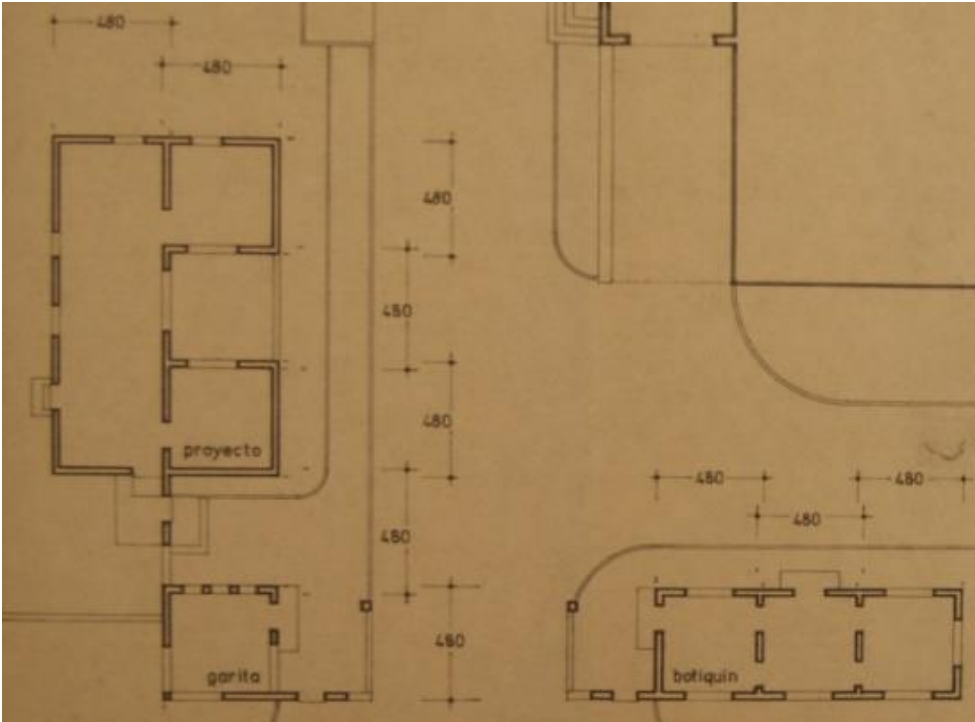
Planta del proyecto de vivienda para el portero. (AMV 1983b)
